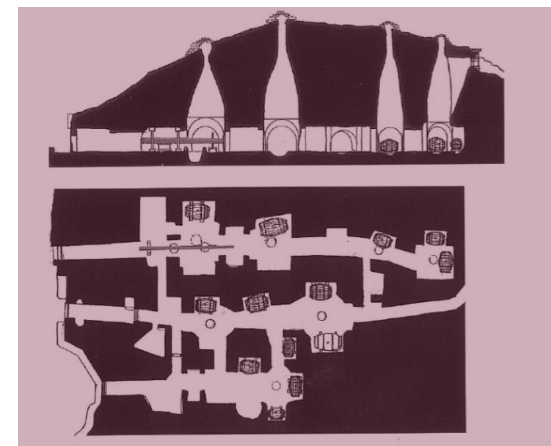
Esquema de la bodega de Ardoncino. Chozas de abajo, León. Planta y sección. (Fuente: Félix Jové, 2021).
